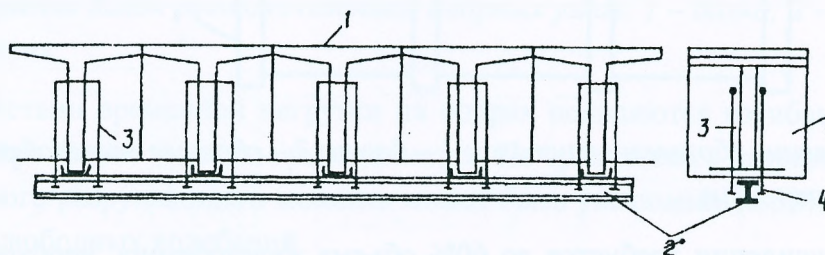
Усиление поперечными балками: 1 – ребристые балки пролетного строения; 2 – металлическая поперечная балка; 3 – тяги; 4 – гайки.
